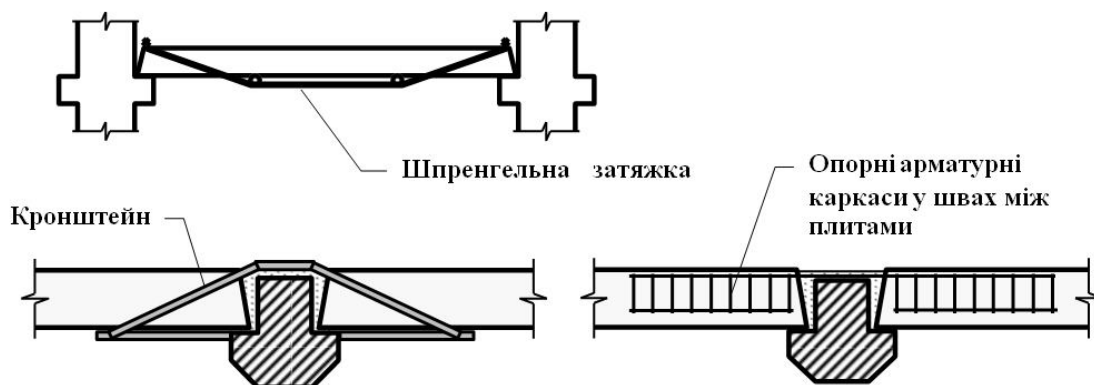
Підсилення залізобетонних плит методами зміни
